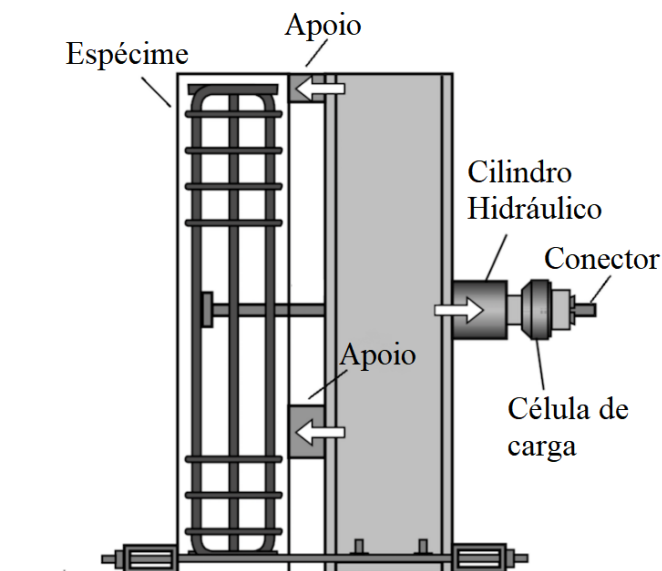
Sistema de ensaio de conexões viga-pilar realizada por Bashandy (Fonte: Adaptado de Thompson *et al.*, 2002).
